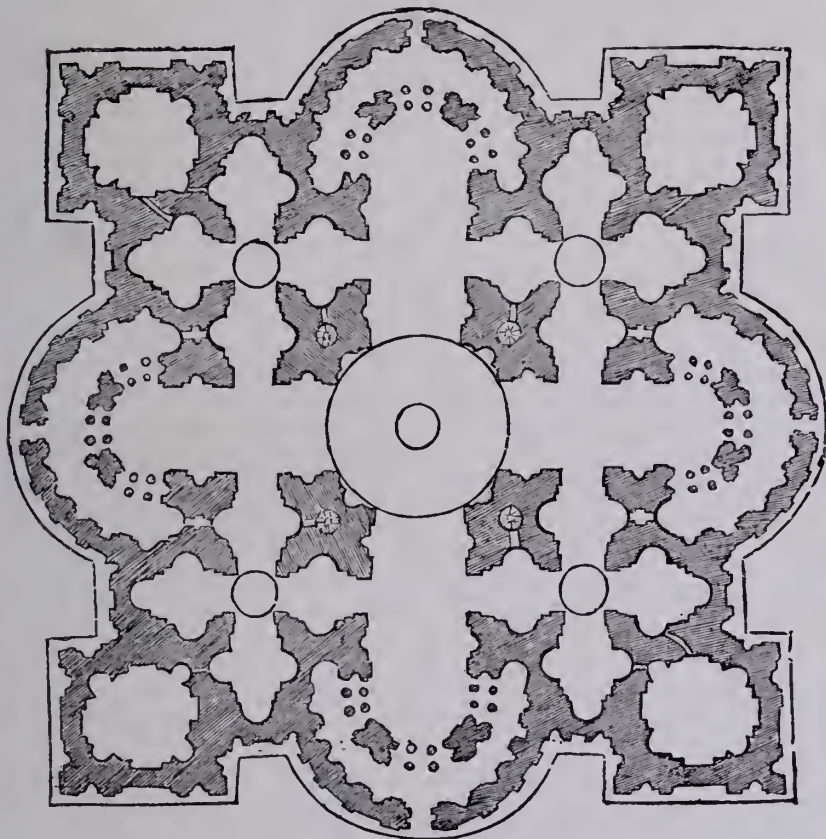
B. Peruzzi: Pianta di S. Pietro.
